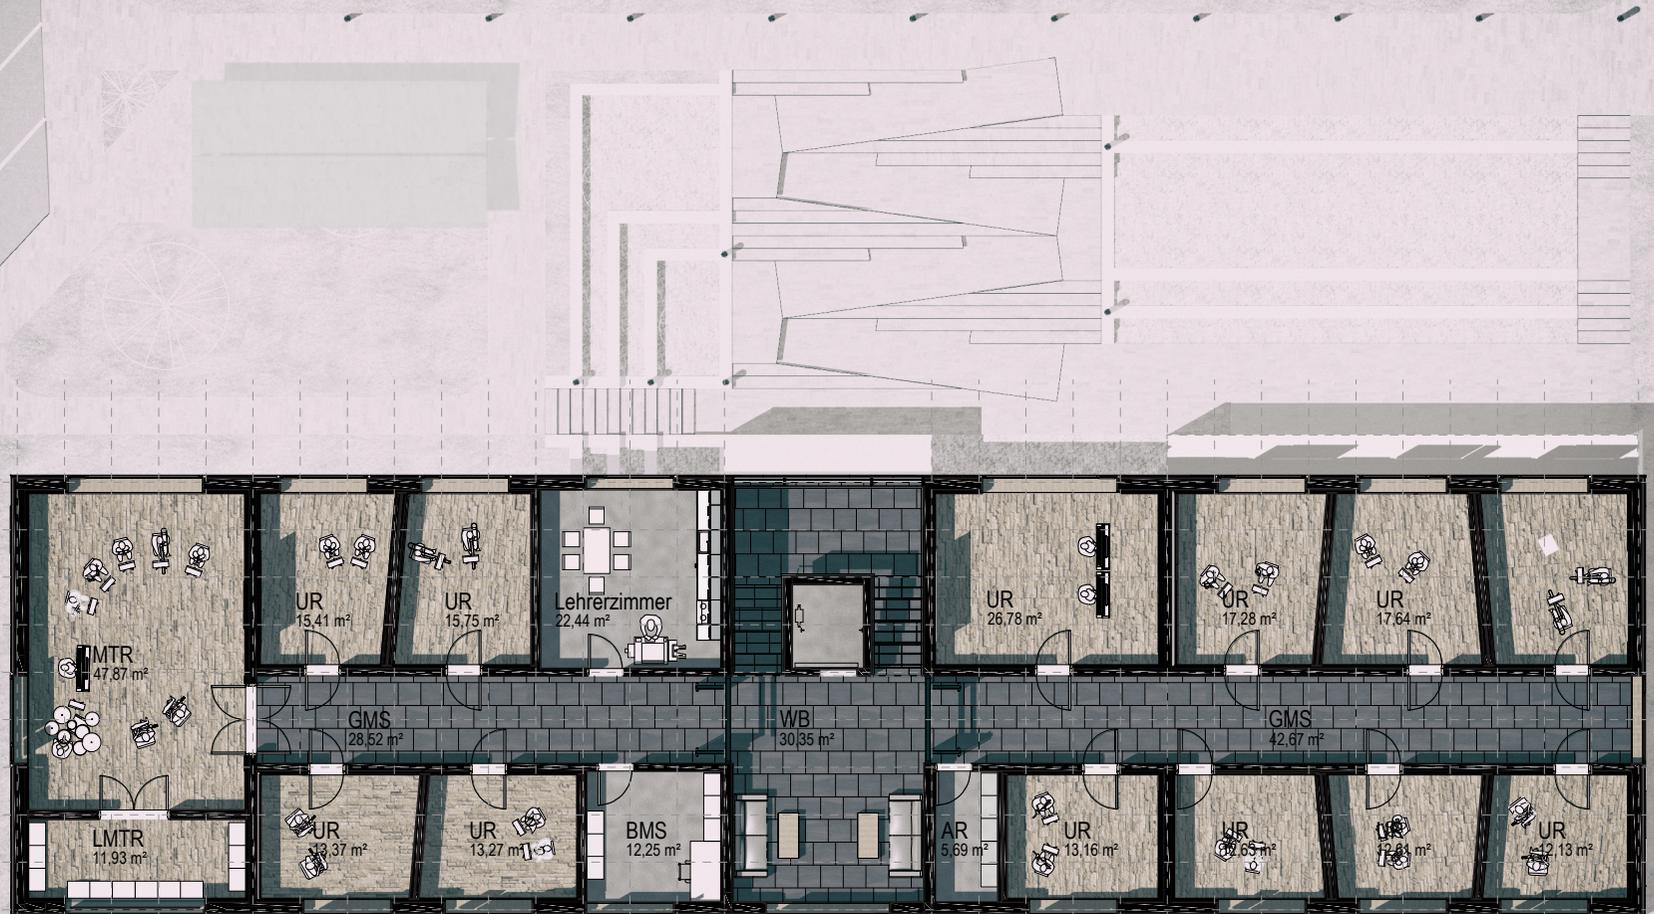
Grundriss Obergeschoss 1:200
